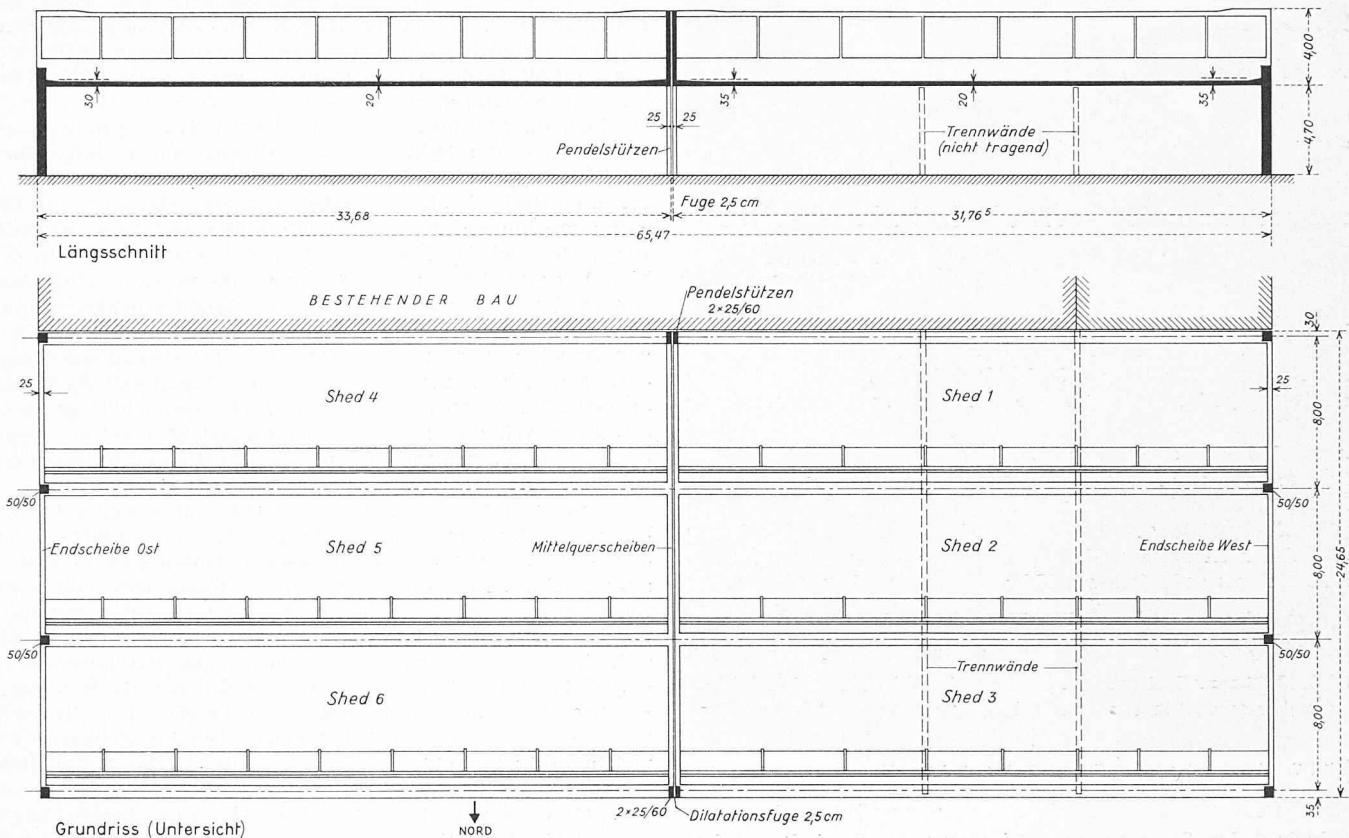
Schalenshed der Sphinxwerke Müller in Solothurn, Grundriss und Längsschnitt 1:400.
